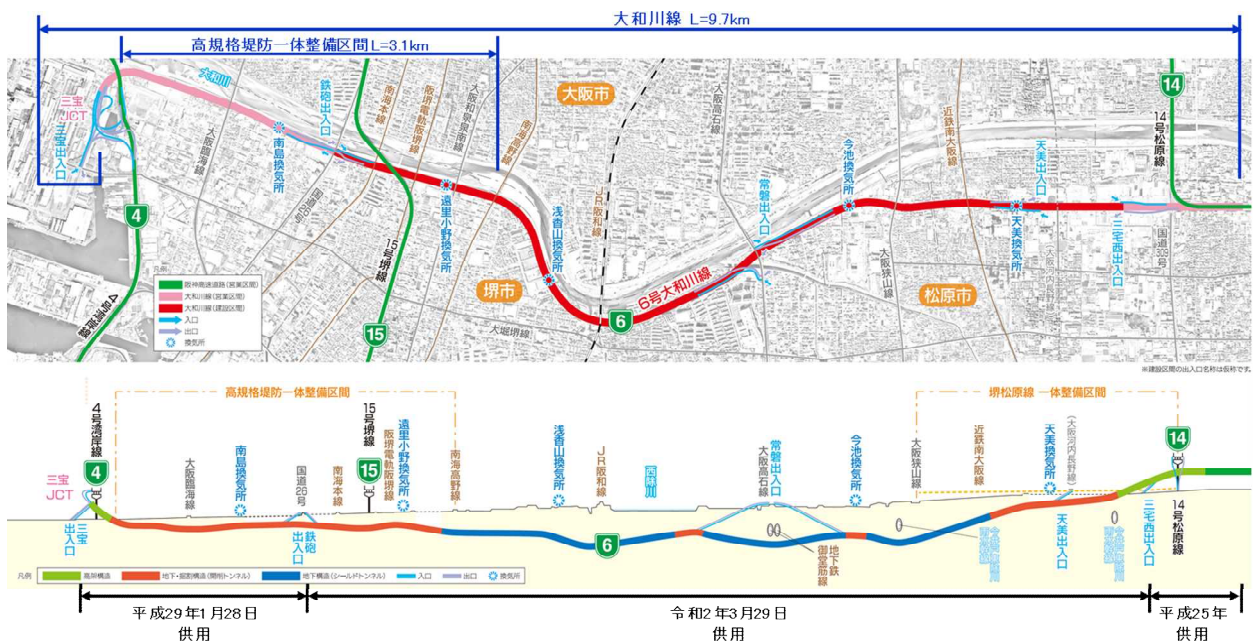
阪神高速大和川線平面図及び断面図(阪神高速大和川線事業のパンフレットに加筆)
